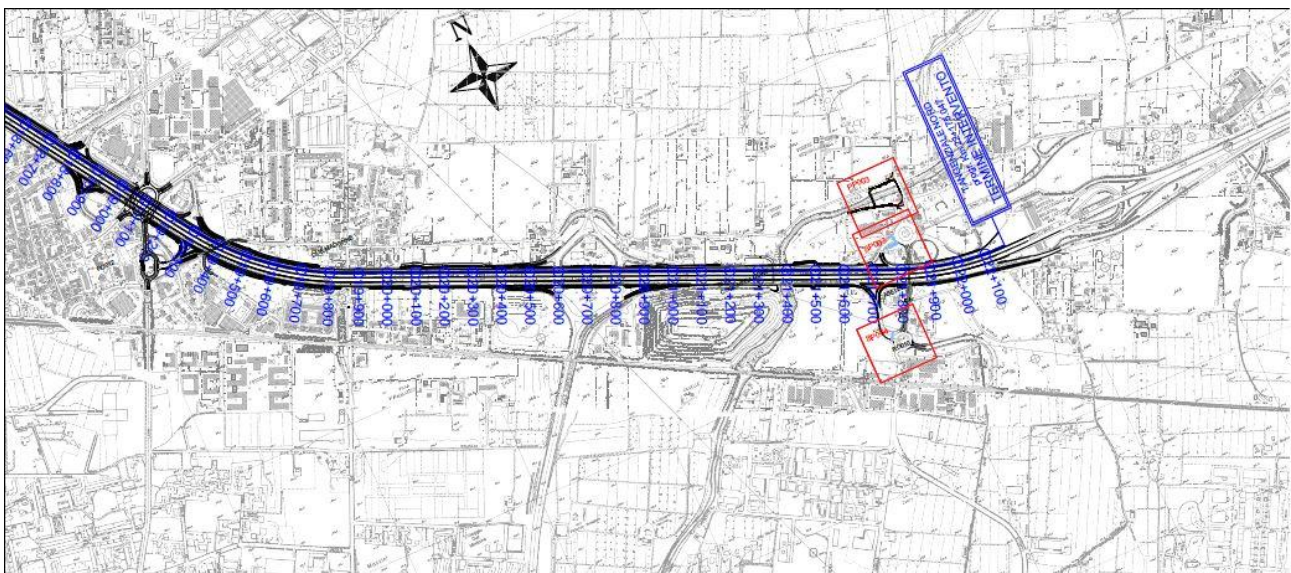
Planimetria dell'area di intervento (parte 4) (in rosso le principali opere connesse ricadenti nel Lotto 1).
